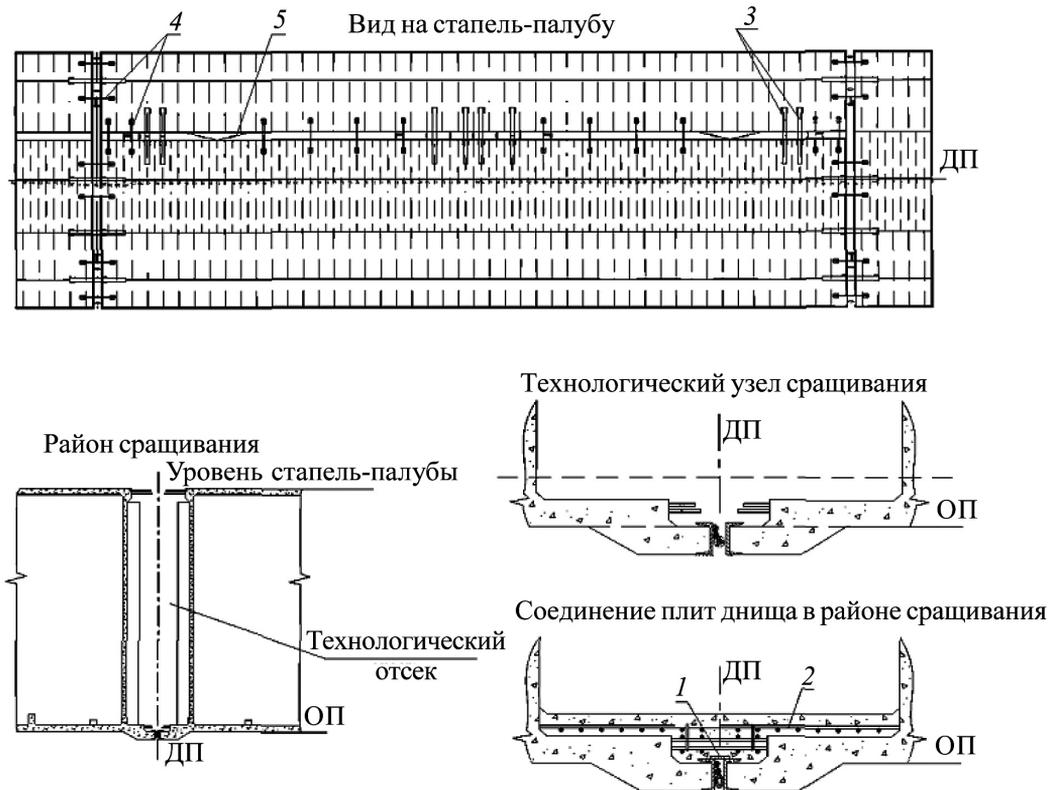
Схема продольного сращивания полукопусов железобетонного понтона: 1 — металлическая полоса, герметизирующая район сращивания; 2 — арматурная сетка на стапель-палубе; 3 — парные центрующие балки с замковым соединением; 4, 5 — поперечные и продольные стяжки соответственно
